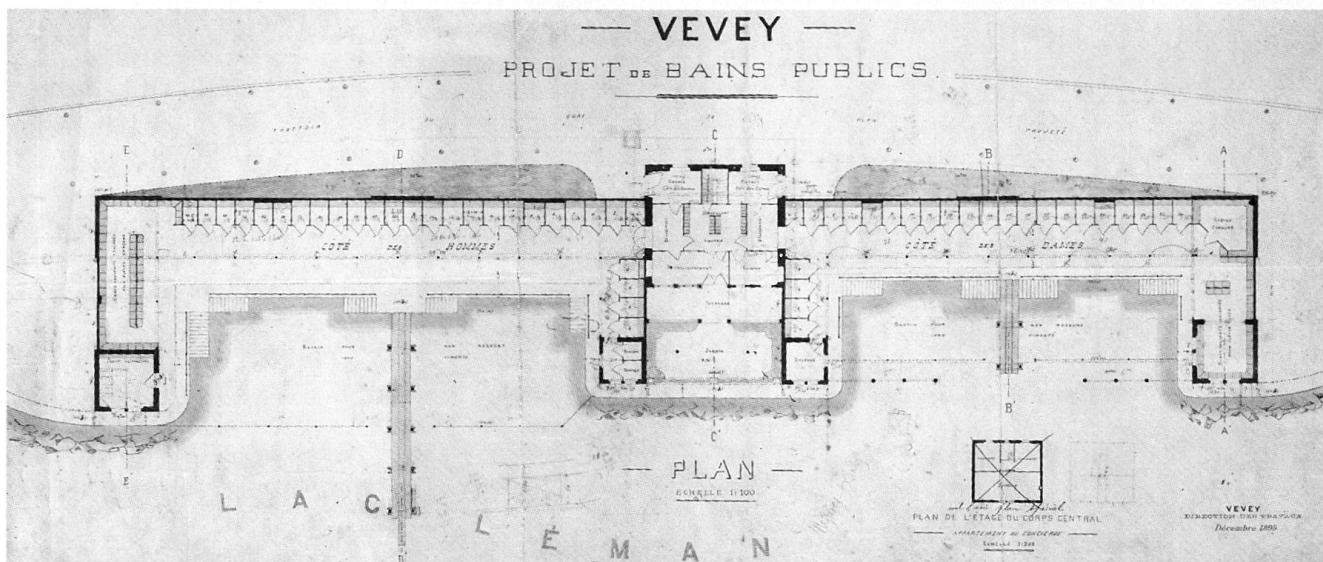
Projet de bains publics, plan dressé en janvier 1895 par la Direction des travaux de la Commune.
